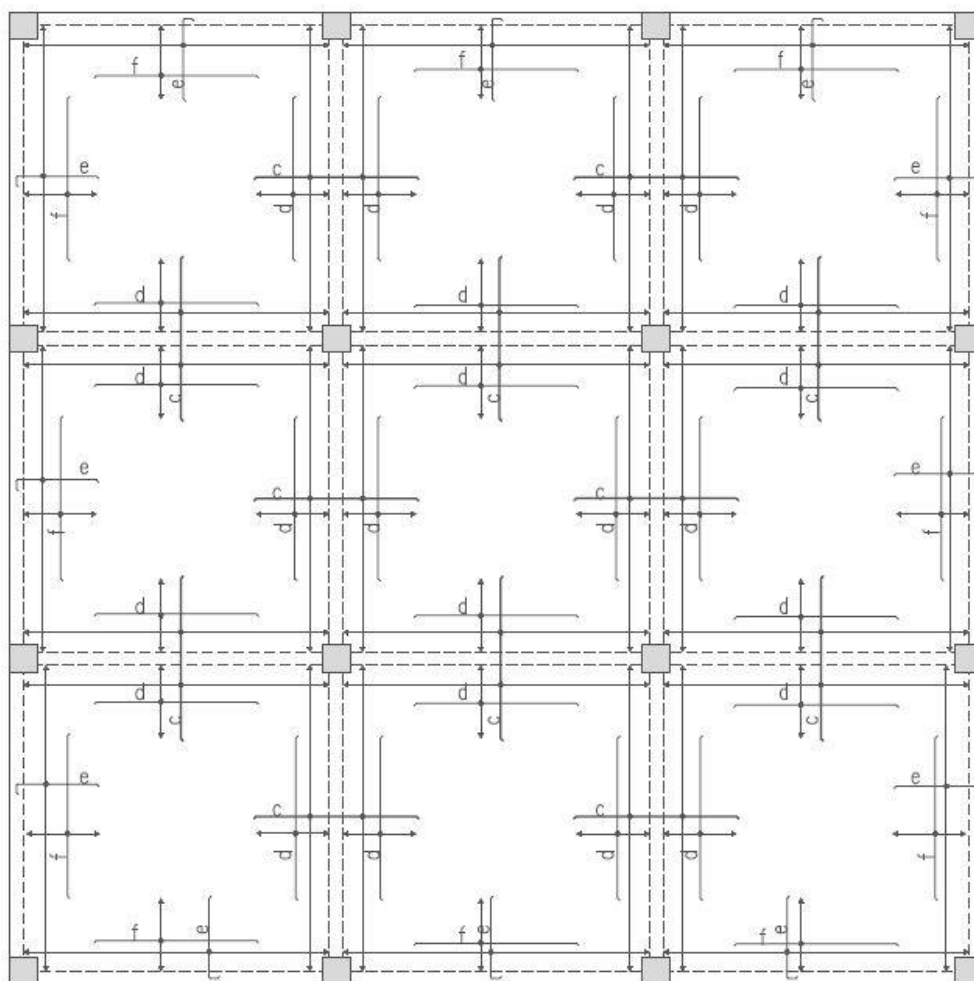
Pormenorização de laje de acordo com o EC2 para as armaduras superiores
